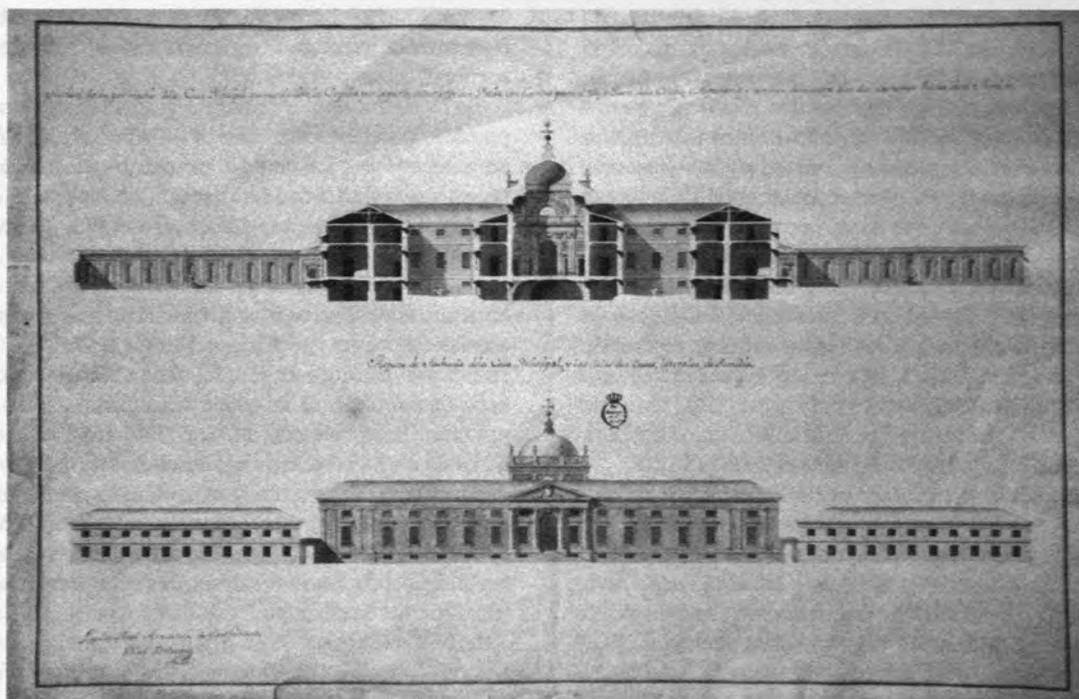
Blas Beltrán Rodríguez, *Proyecto de una Casa de Campo*. Sección y fachada (Academia de San Fernando).
